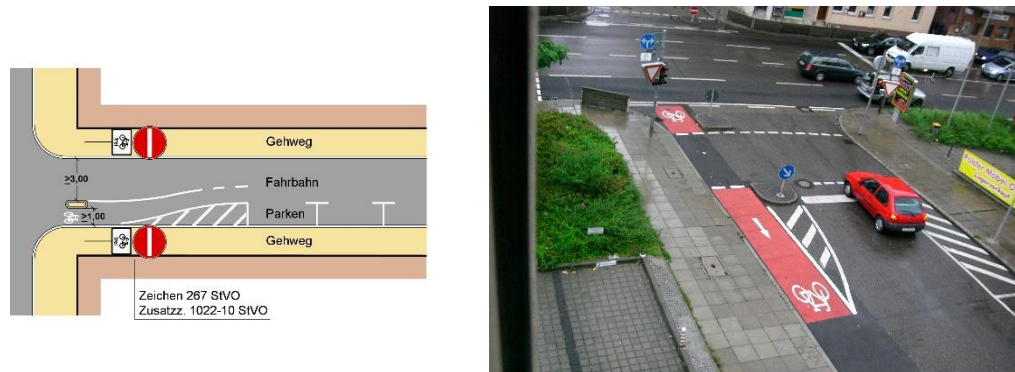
Prinzipskizze und Beispiel (Stuttgart) zur baulichen Ausgestaltung einer Einfahrpforte
